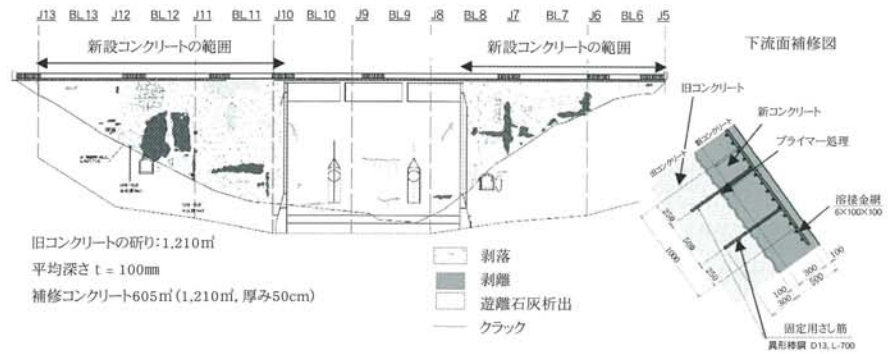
凍害によるコンクリートダム堤体表面の打替え¹²⁾
